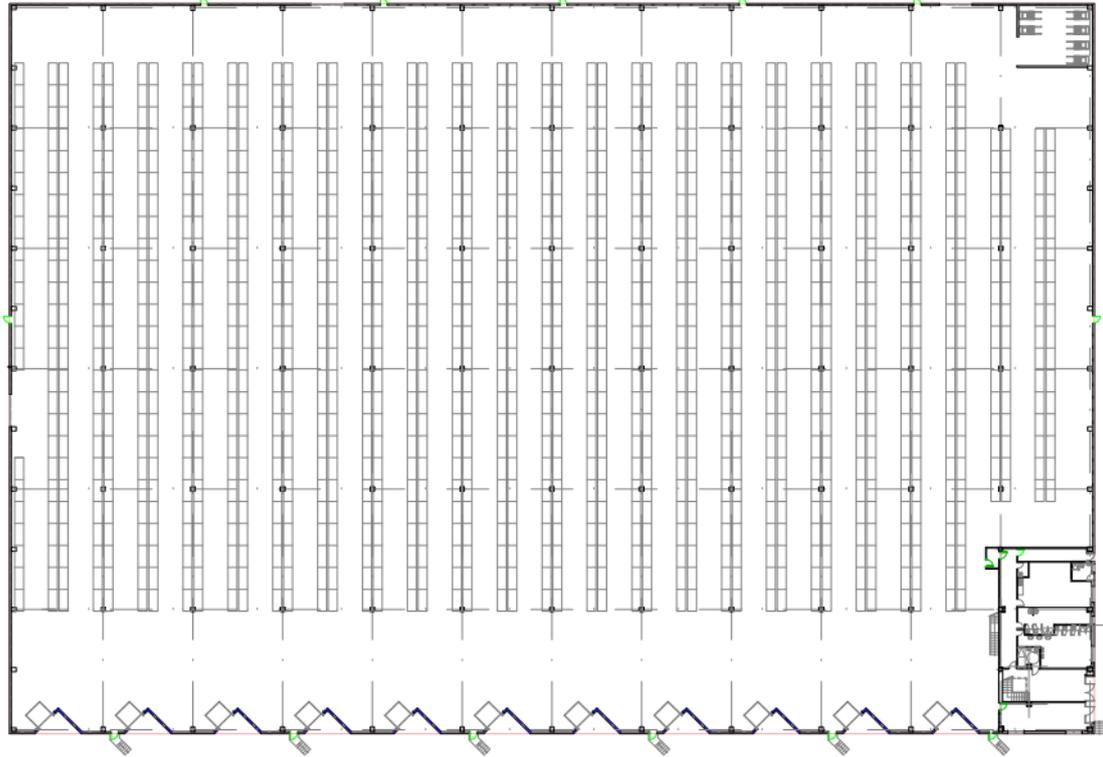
Vista planta nave con implantación. Cotas en Anexos.
